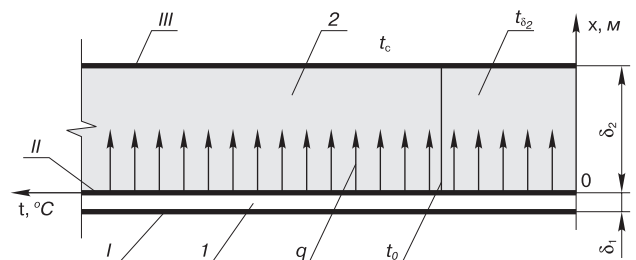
Схема для расчета теплопереноса в монолитном железобетонном перекрытии при использовании термоактивной опалубки: 1 – термоактивная опалубка толщиной δ_1 , создающая тепловой поток интенсивностью q ; 2 – слой бетона толщиной δ_2 ; t_0 – начальная температура бетонной смеси; t_c – температура наружной среды. I – наружная поверхность термоактивной опалубки; II – поверхность контакта термоактивной опалубки и бетона; III – поверхность контакта бетона и окружающей среды
